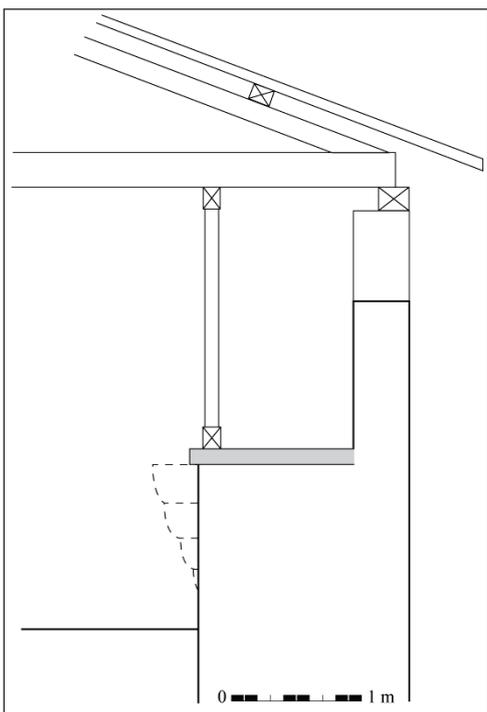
croquis à l'échelle de la coupe est/ouest du mur est au troisième étage
